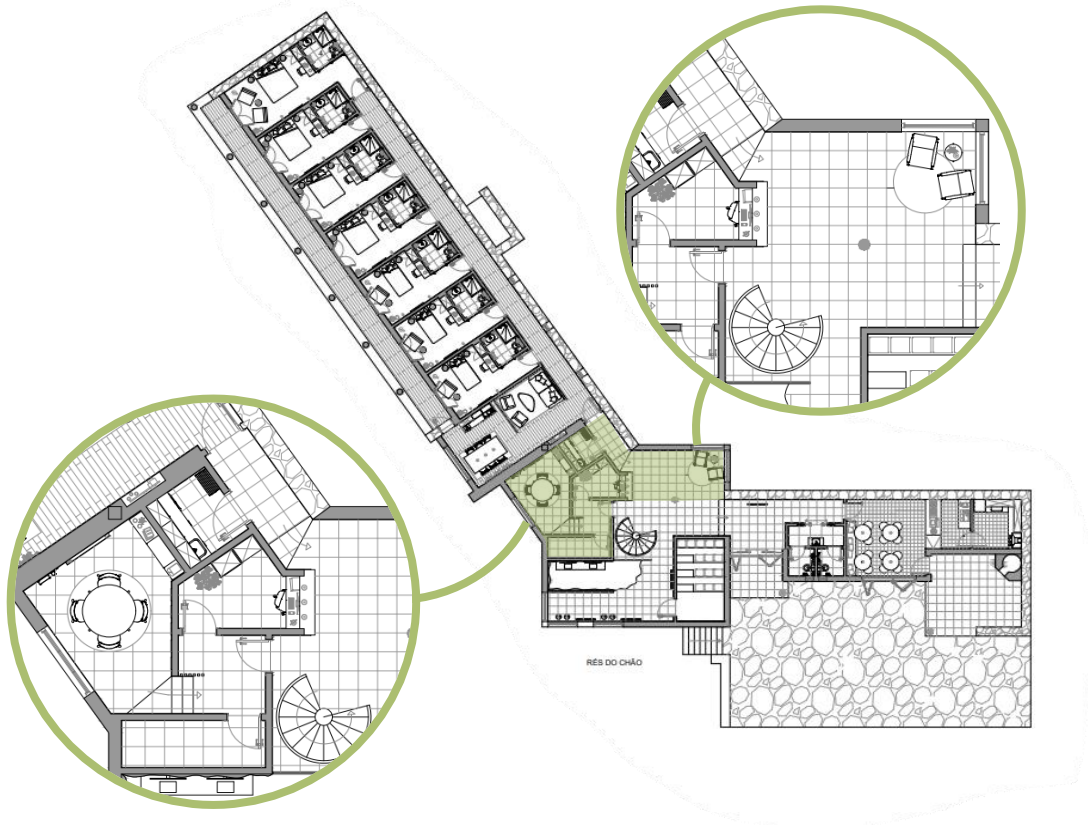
Planta de Apresentação com detalhes da zona de recepção. Fonte: Autor.
